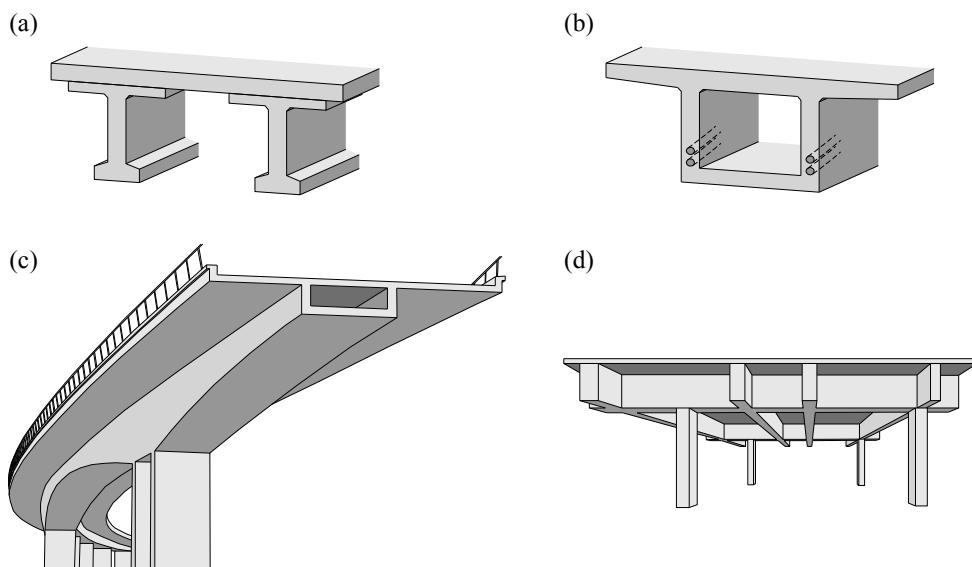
Potentiell schubkritische Stahlbeton- und Spannbetonelemente: (a) Stahlbeton- oder Spannbetonträger mit dünnem Trägersteg; (b) dünnwandiger Steg eines vorgespannten Kastenbrückenträgers; (c) Brücke mit Kastenquerschnitt und (d) Unterzugsdecke.
